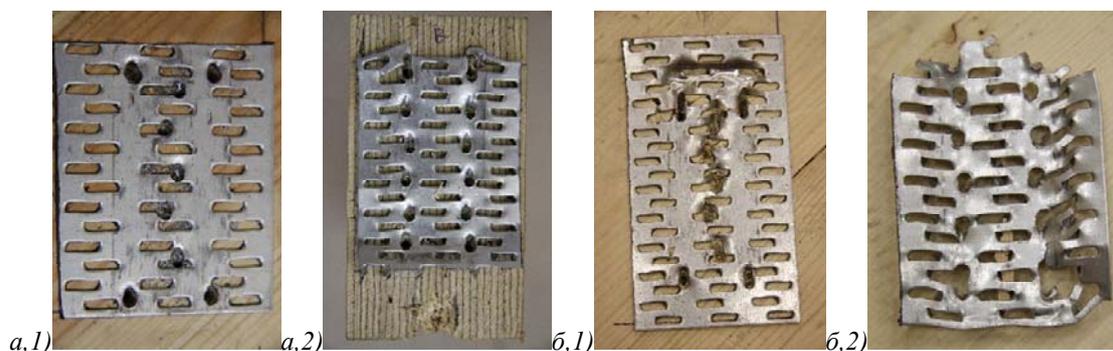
Виды разрушения МЗП в элементах деревянных конструкций: а,1)-а,2) стеновой панели из *CLT* и балки из *CLT*; б,1) – б,2) стеновой панели из *CLT* и балки из *LVL
